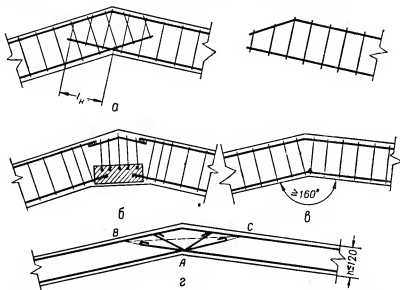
126. Армирование сварными каркасами и сетками входящих узлов железобетонных конструкций:
